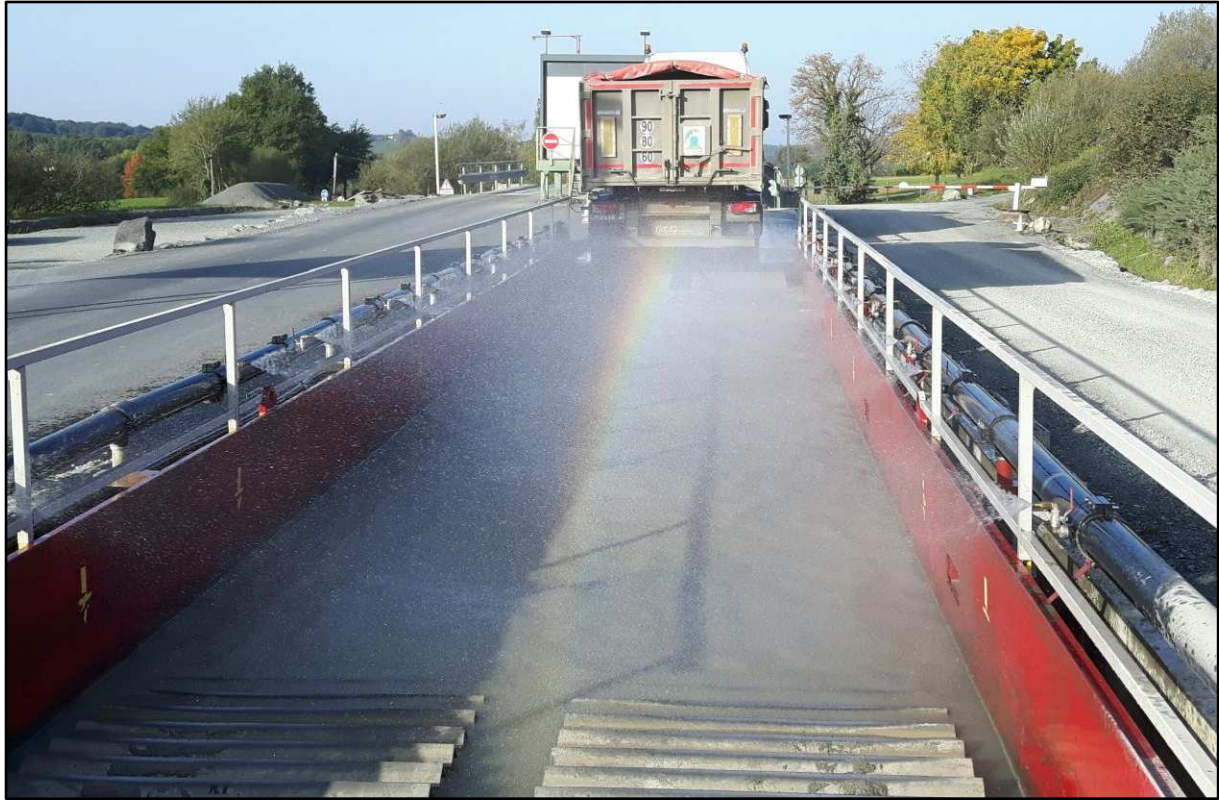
Dispositif de nettoyage des roues qui sera mis en place en sortie de site (photo issue d'un autre site de l'exploitant)
